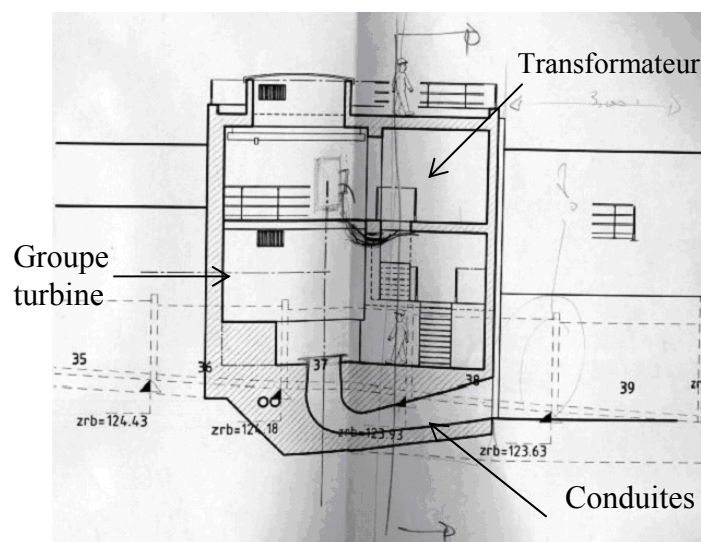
Représentation des câbles d'un boîtier électrique sur une coupe verticale d'une usine.
